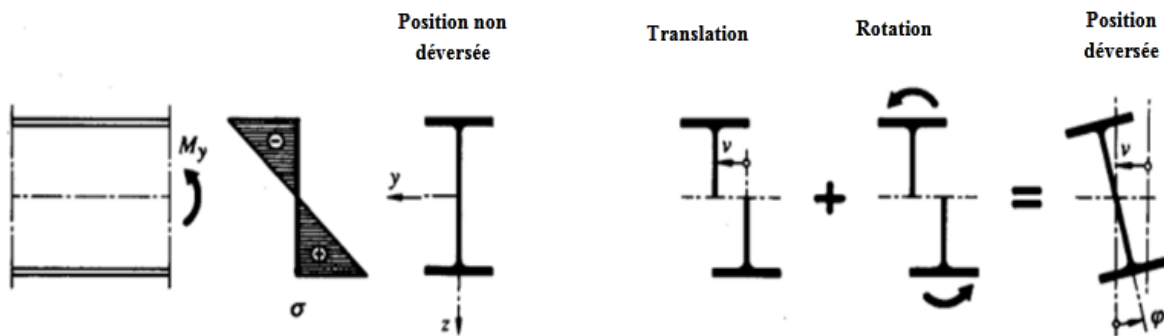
Translation et rotation d'une section d'un élément de poutre sujet au déversement.
